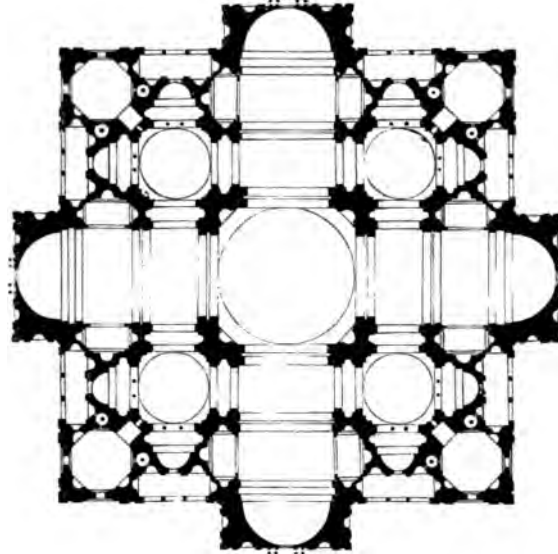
St. Peter. Bramantes erster Grundriss.
